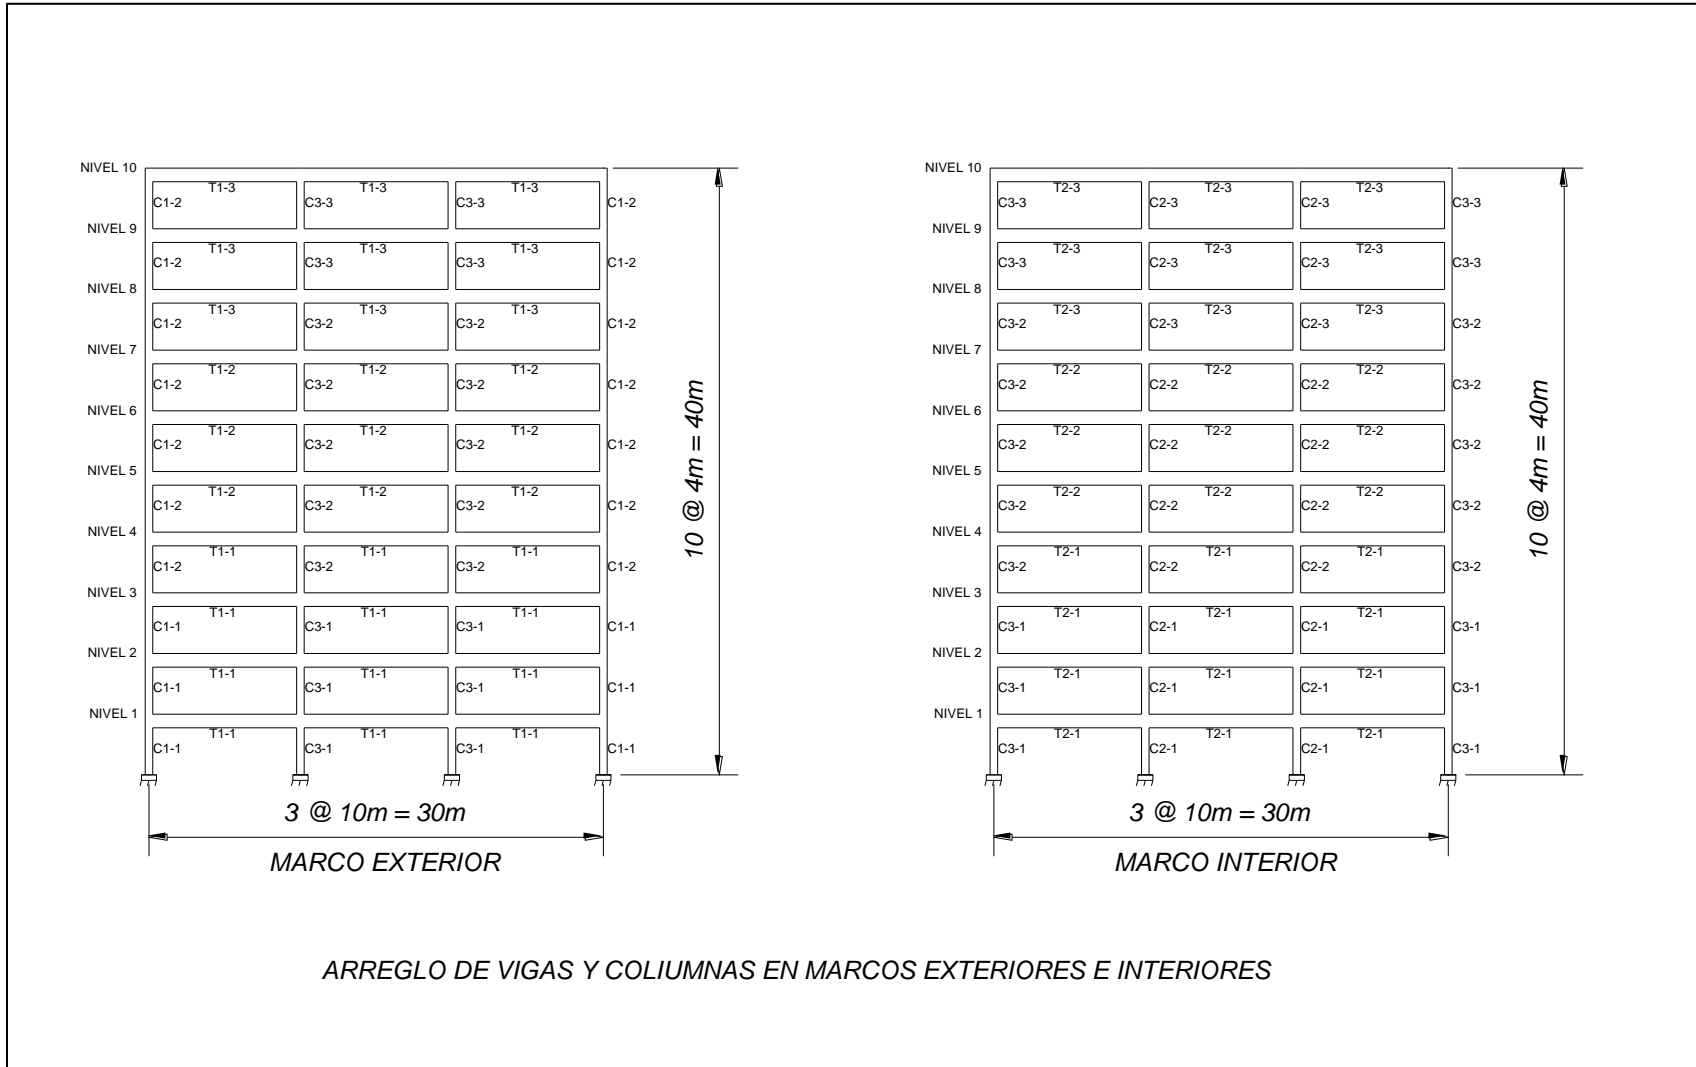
Detalles estructurales del edificio de 10 niveles diseñado con el ACI318-08
